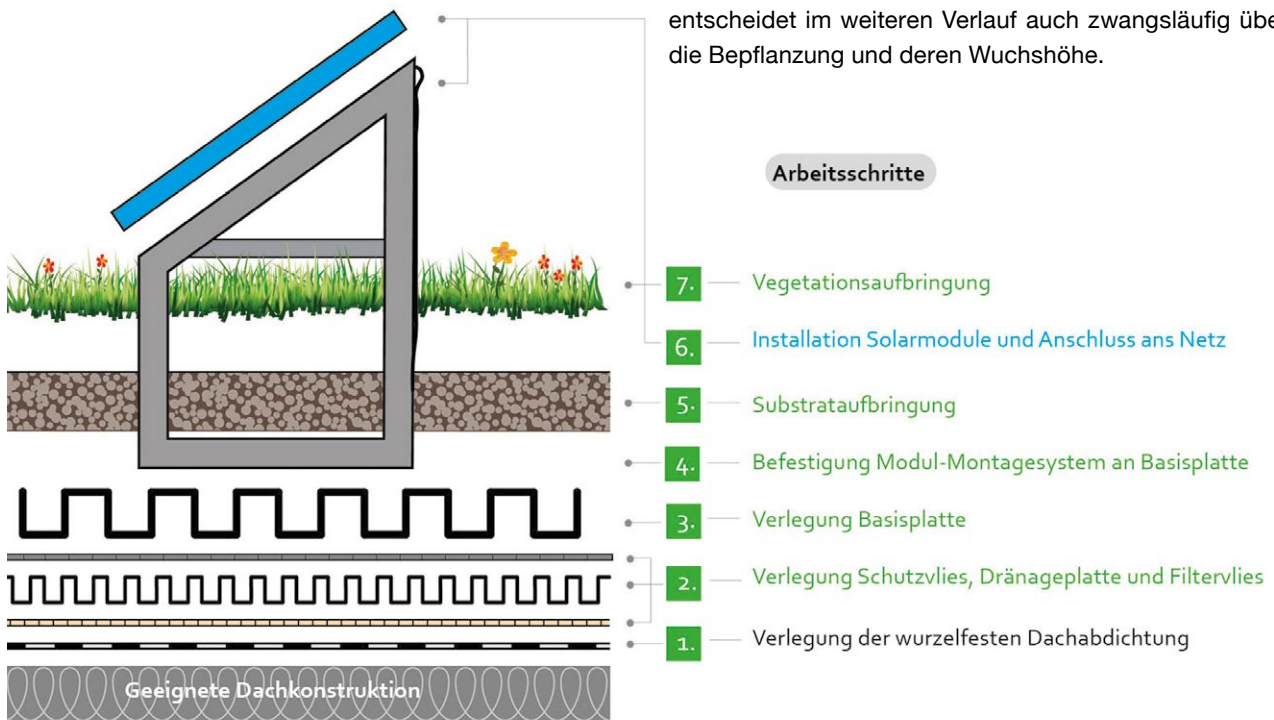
Dachaufbau eines Solar-Gründachs (Quelle: Bundesverband GebäudeGrün).
